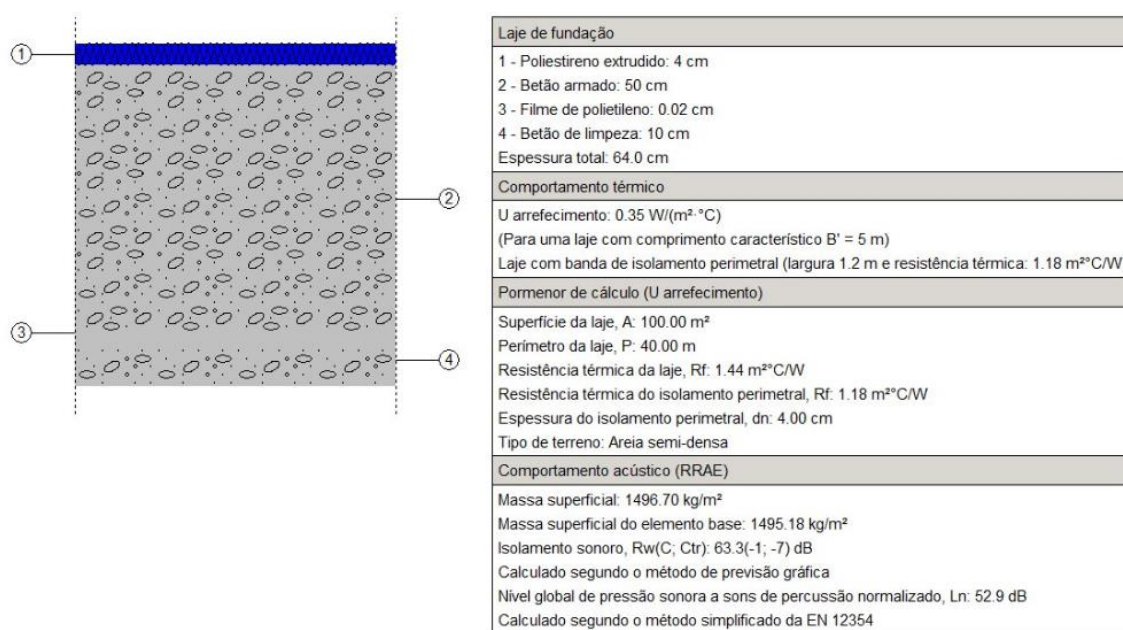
Constituição esquemática de pavimento térreo (Software CYPE)
